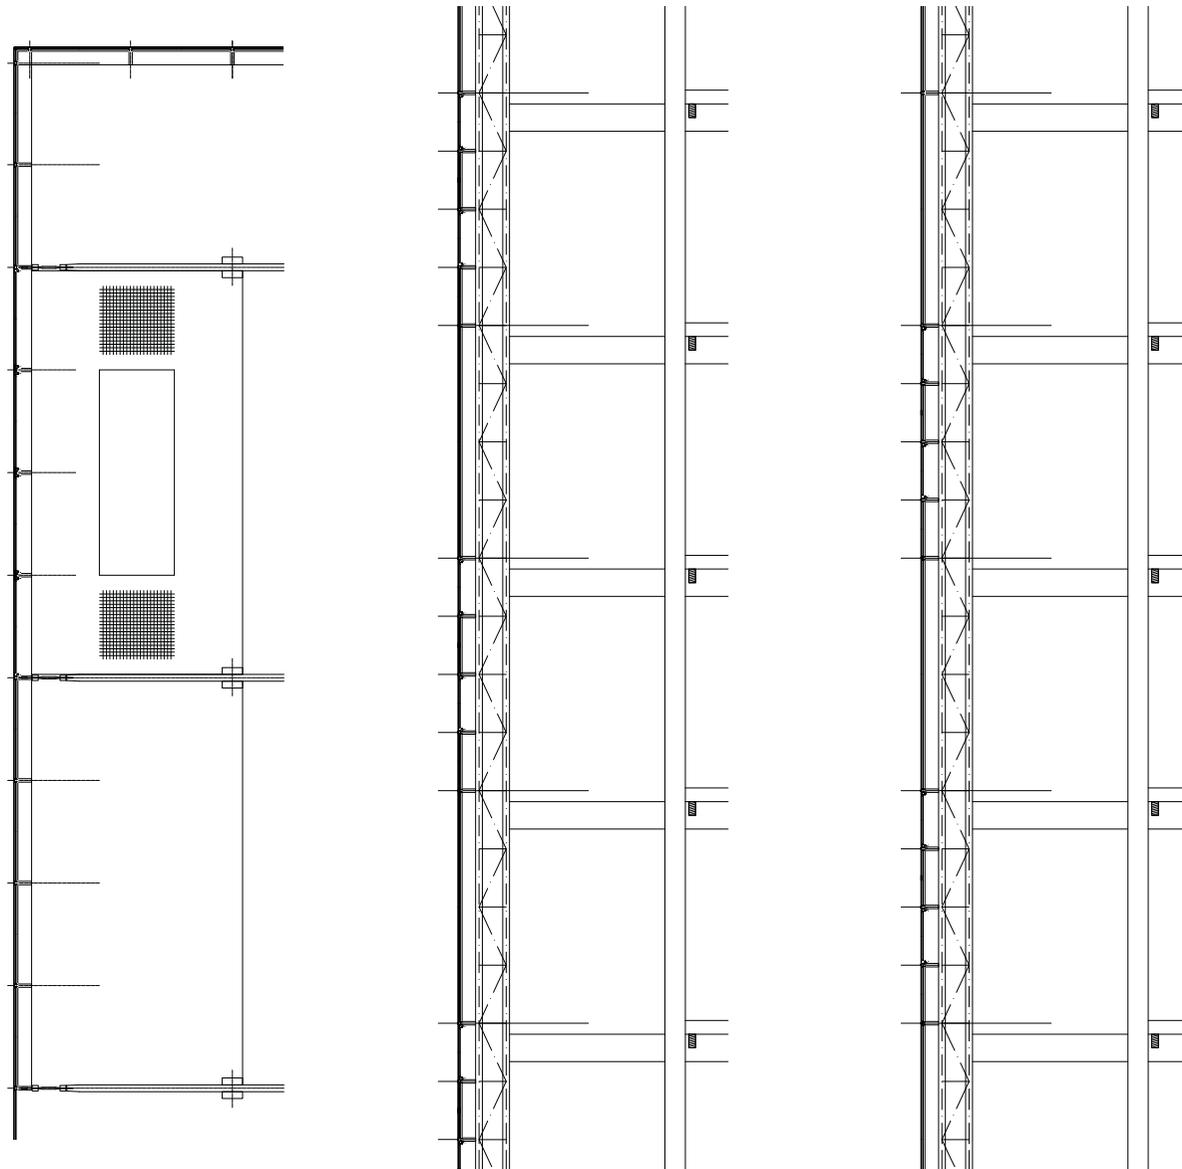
Fassadendetail, Horizontal- und Vertikalschnitte. Vollständig transparente Vorhangfassaden. Das Gebäude soll zu allen Zeiten natürlich be- und entlüftet werden. Die Fassade besteht aus einer einschaligen, Sonnenschutz- und Isolierverglasung. Die natürliche Beleuchtung des Innenraums auch in der Tiefe erfolgt neben der Fassade zusätzlich über das Atrium.
